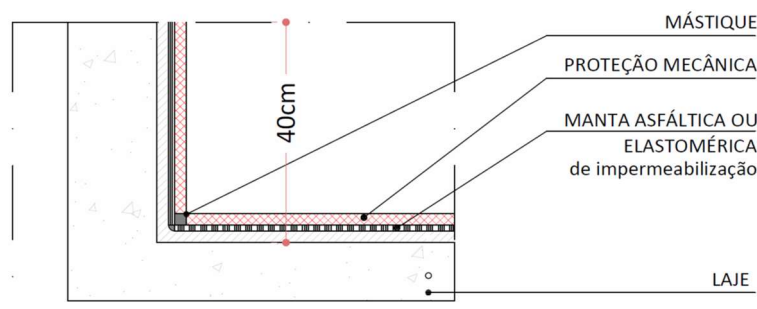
Detalhe de como deve ser feita a Impermeabilização + Proteção mecânica de Lajes de Cobertura
